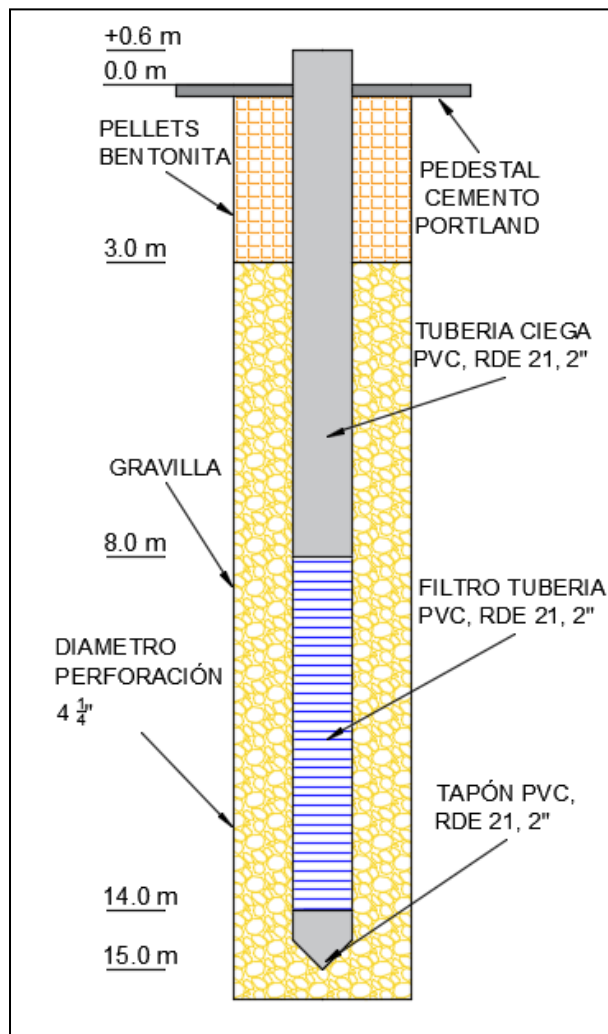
160. Diseño y características constructivas de los cuatro piezómetros levantados en el presente estudio. Fuente: Elaboración propia
